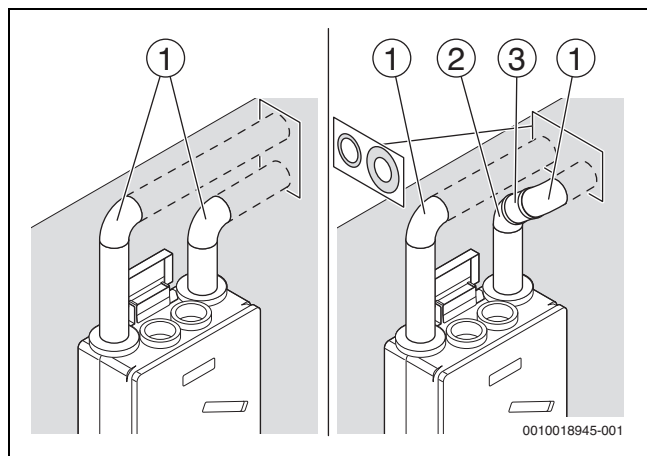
Anschlussdetails zu Bild 36 bis 38: Rohrführung Außen-/Fortluftleitung
